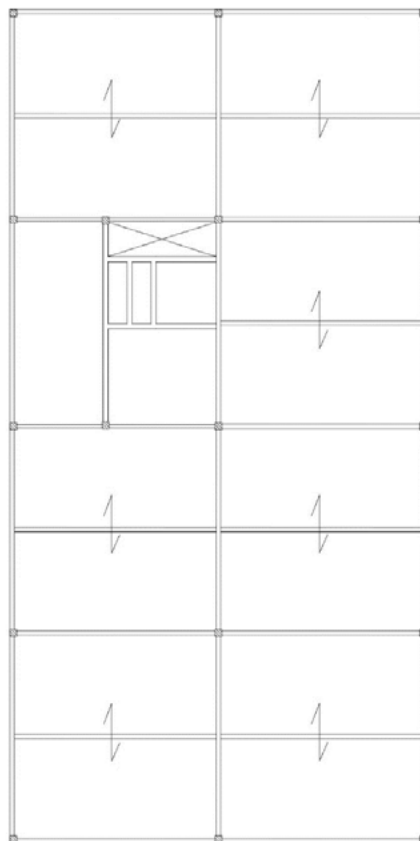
Planta baixa do pavimento tipo do modelo em estrutura mista aço-concreto.
